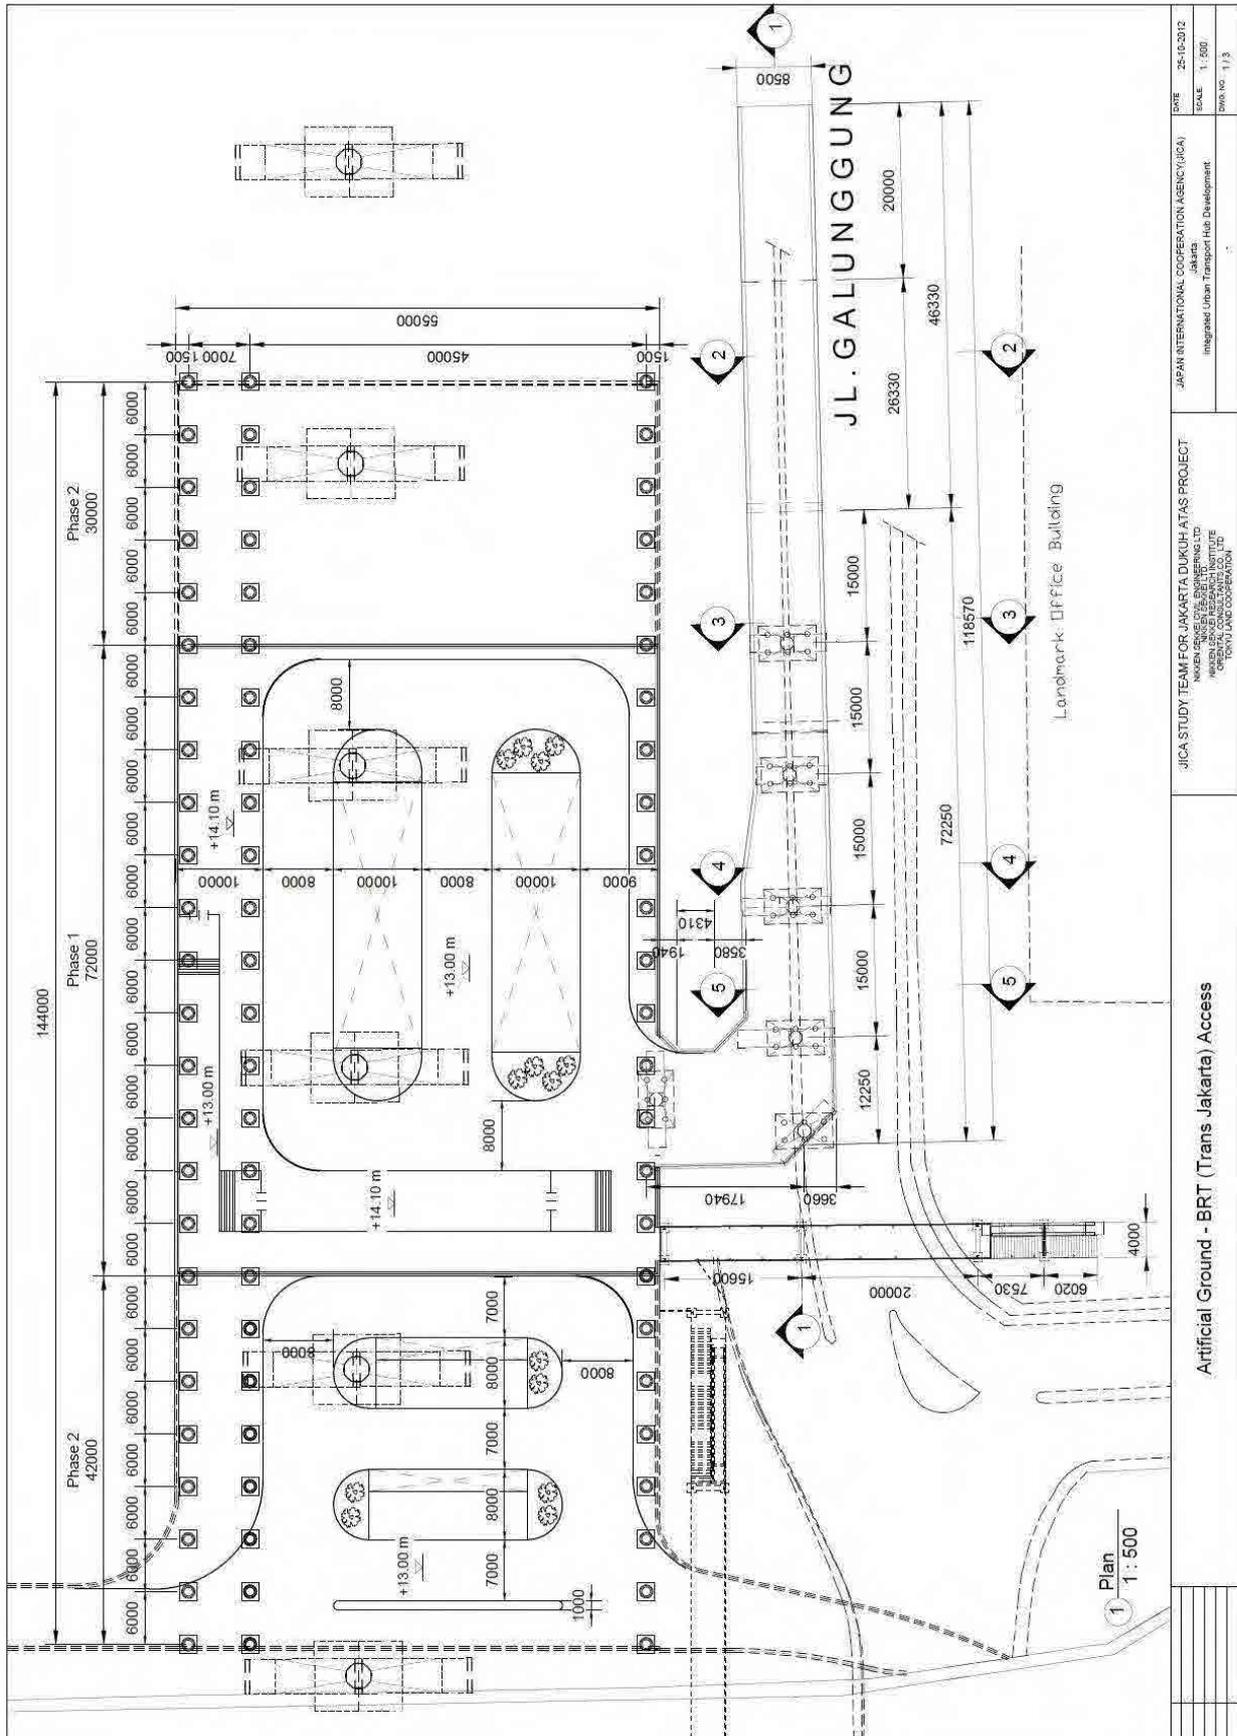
Phase-1 部分平面図 (出典：調査団)
